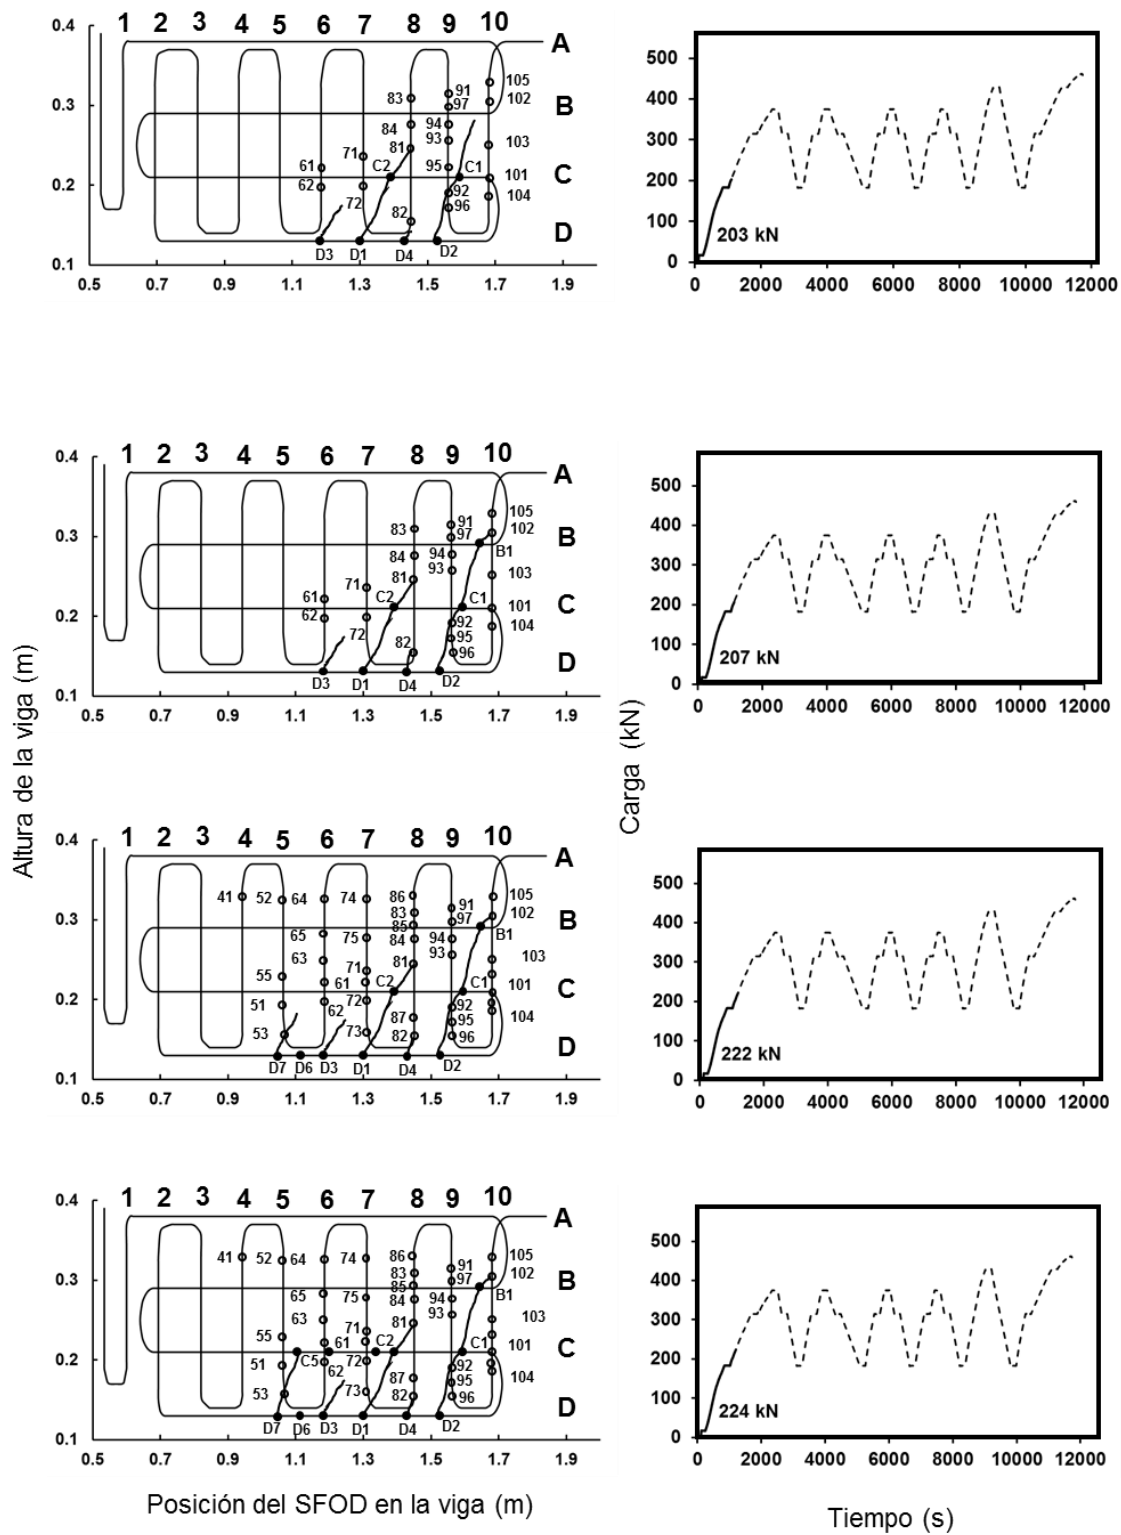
Patrones de fisuración de la viga I-3 (203 a 224 kN)
